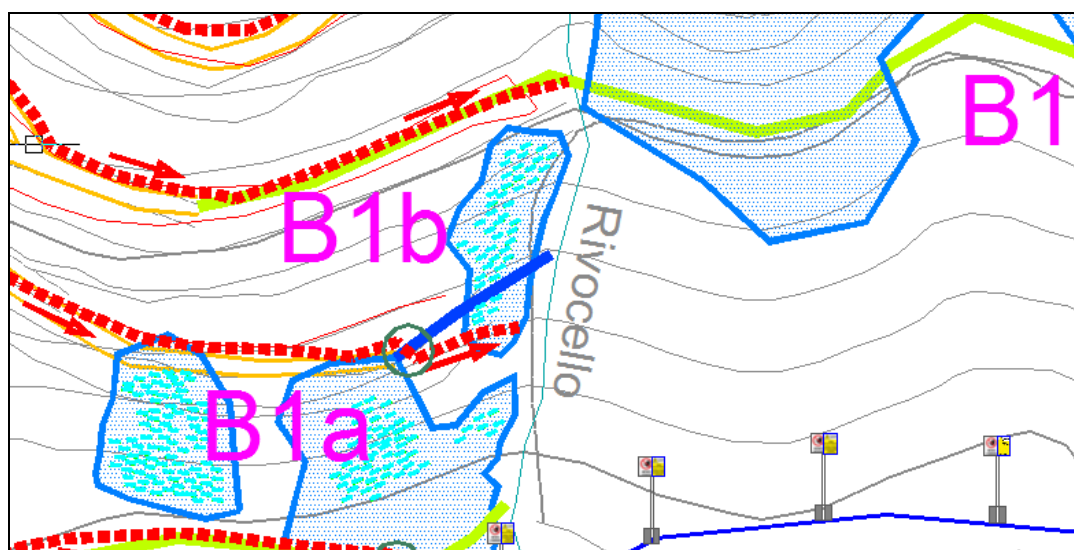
Unità progettuale B1b (cfr. elaborato C2 - Planimetria generale di progetto)
